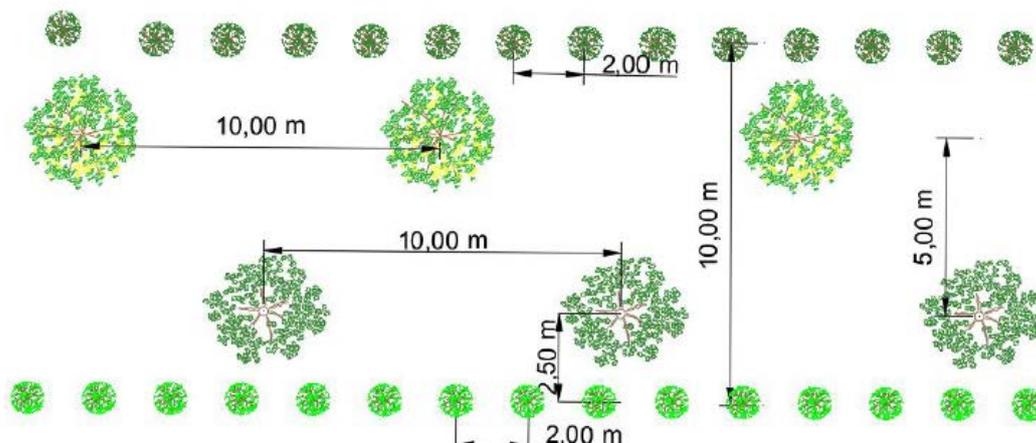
Layout di impianto delle specie vegetali previsti a mitigazione della SSE utente e SE RTN
